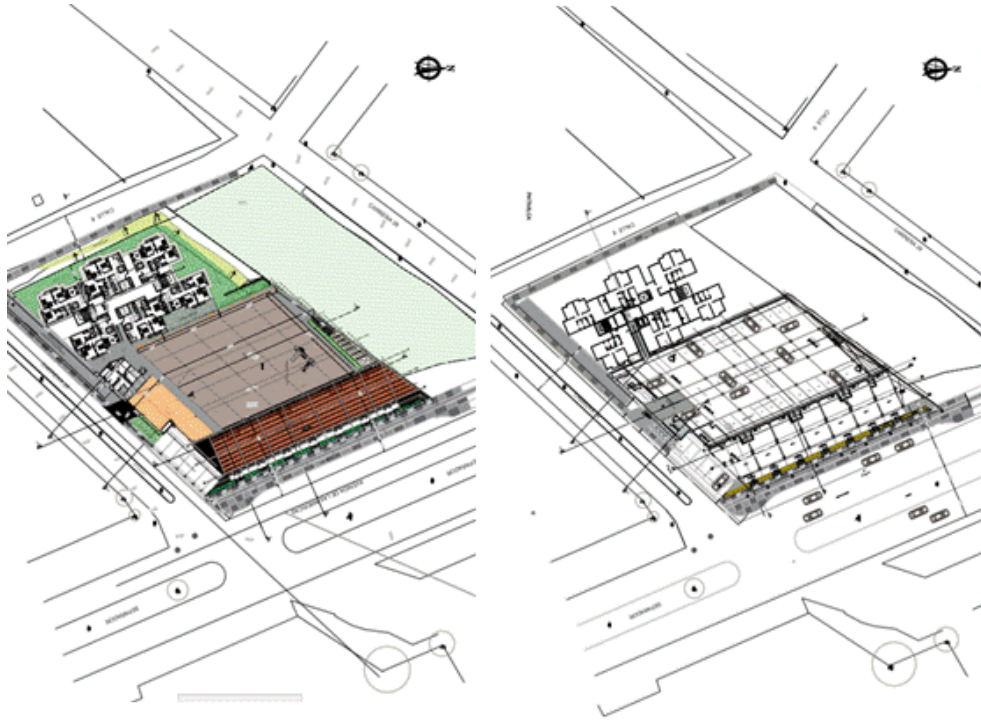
ARQUITECTÓNICO DEL EDIFICIO. FUENTE: CONSTRUCTORA
